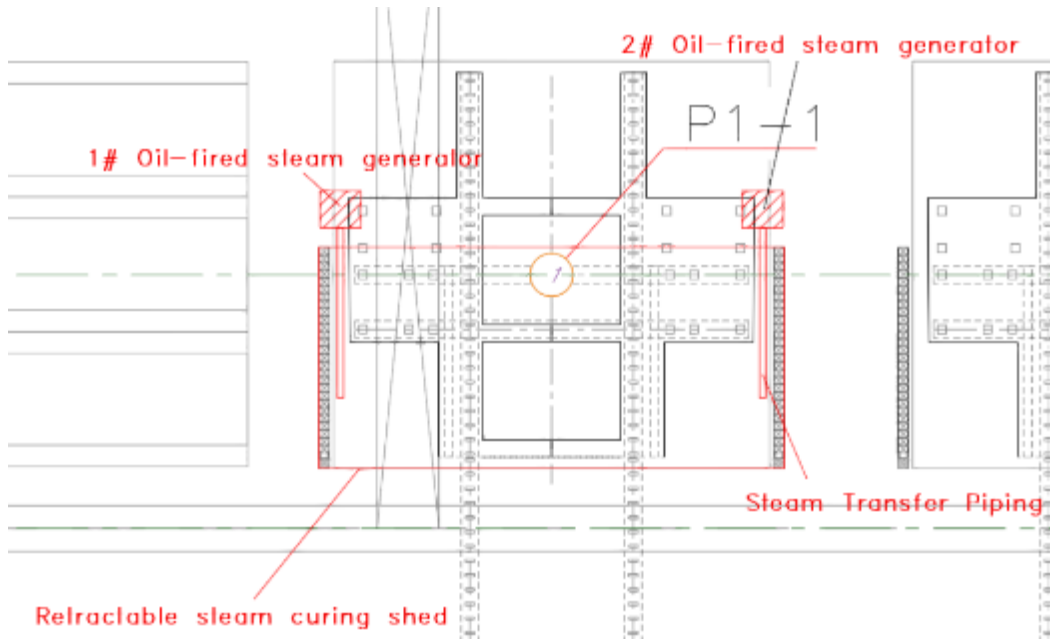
Vista en planta de ubicación de los dos generadores por pedestal
